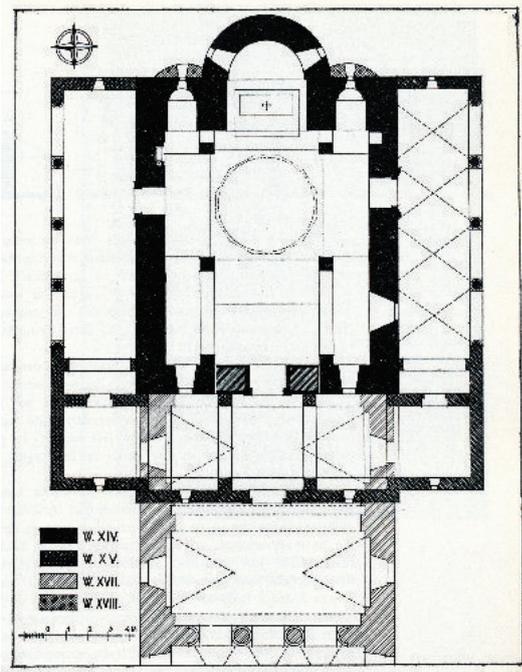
Armenische Kathedrale der Himmelfahrt Mariä, Grundriss, Lwiw.
